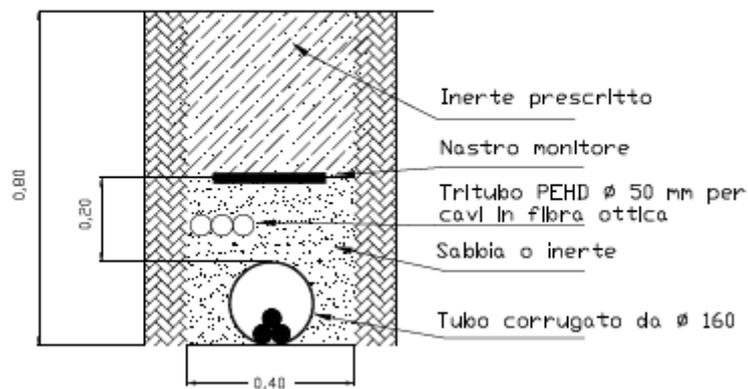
Sezione su strada sterrata o terreno agricolo - posa di n°1 cavo MT
